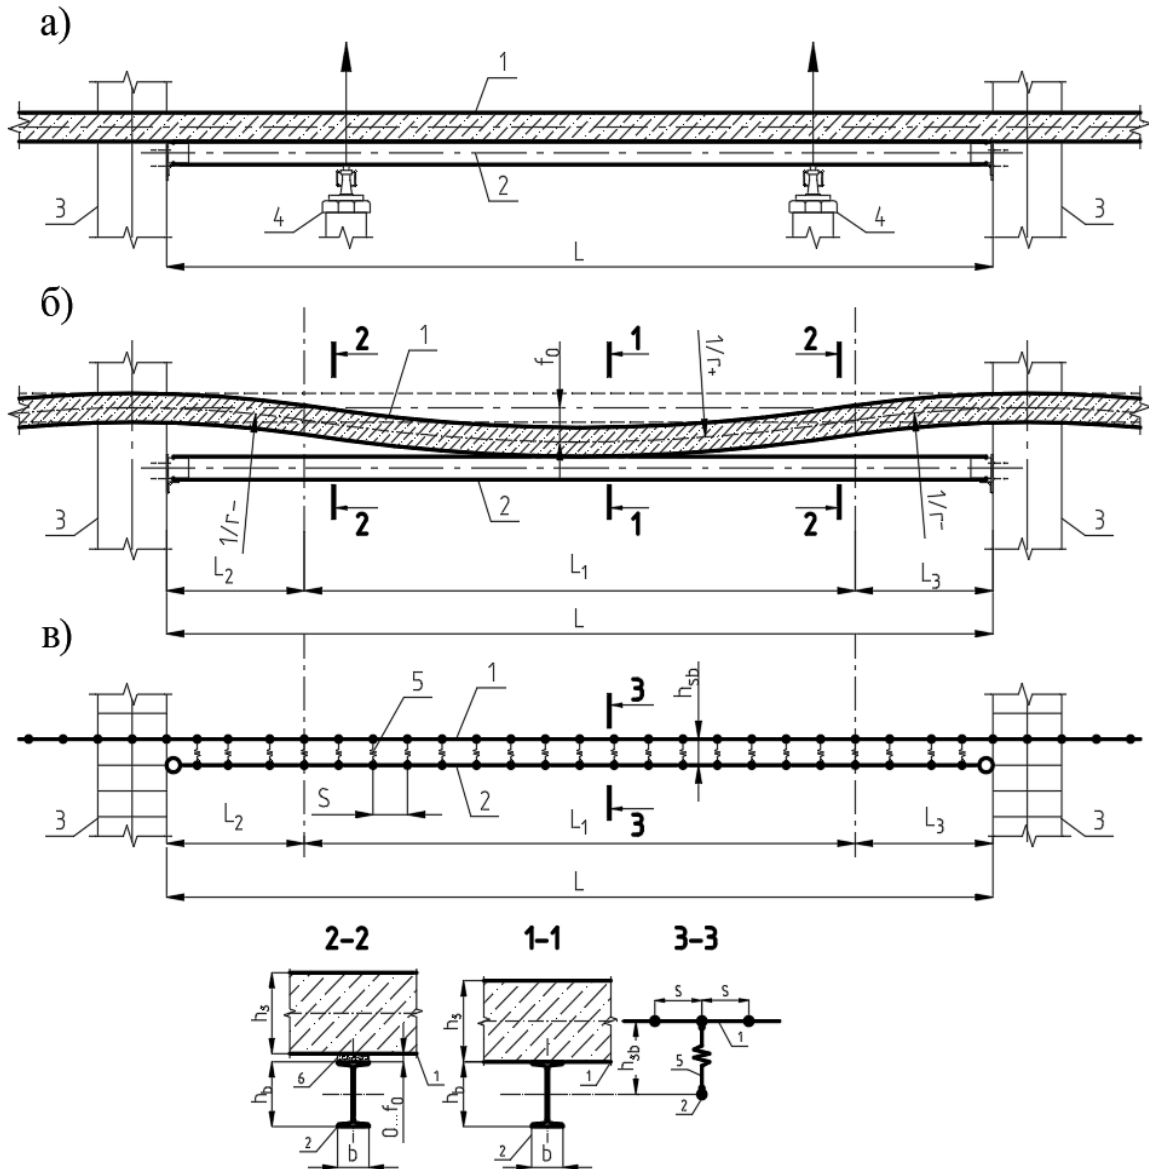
До складання розрахункової схеми: а – схема влаштування підсилення плити балкою; б – те ж, з гіпертрофованими для наочності деформаціями плити; в – скінчено-елементна інтерпретація схеми; 1 – плита, що підсилюється; 2 – балка підсилення; 3 – вертикальні елементи каркасу; 4 – монтажні домкрати; 5 – односторонні в'язі стиску; 6 – заповнення зазору; L – розрахунковий проліт; L_1 – довжина зони додатної кривизни; L_2 , L_3 – довжини зон від'ємної кривизни; f_0 – початковий прогин плити на момент підсилення; h_s – товщина плити; h_b – ширина балки; h_{sb} – розрахункова висота посиленої конструкції в скінчено-елементній моделі; s – крок триангуляції моделі
